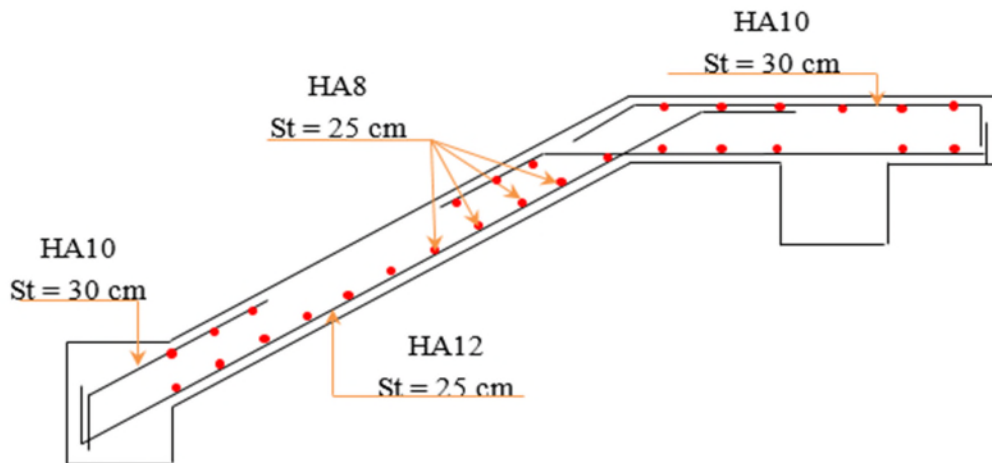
Schéma de ferrailage de l'escalier (volée 1 et 3).
